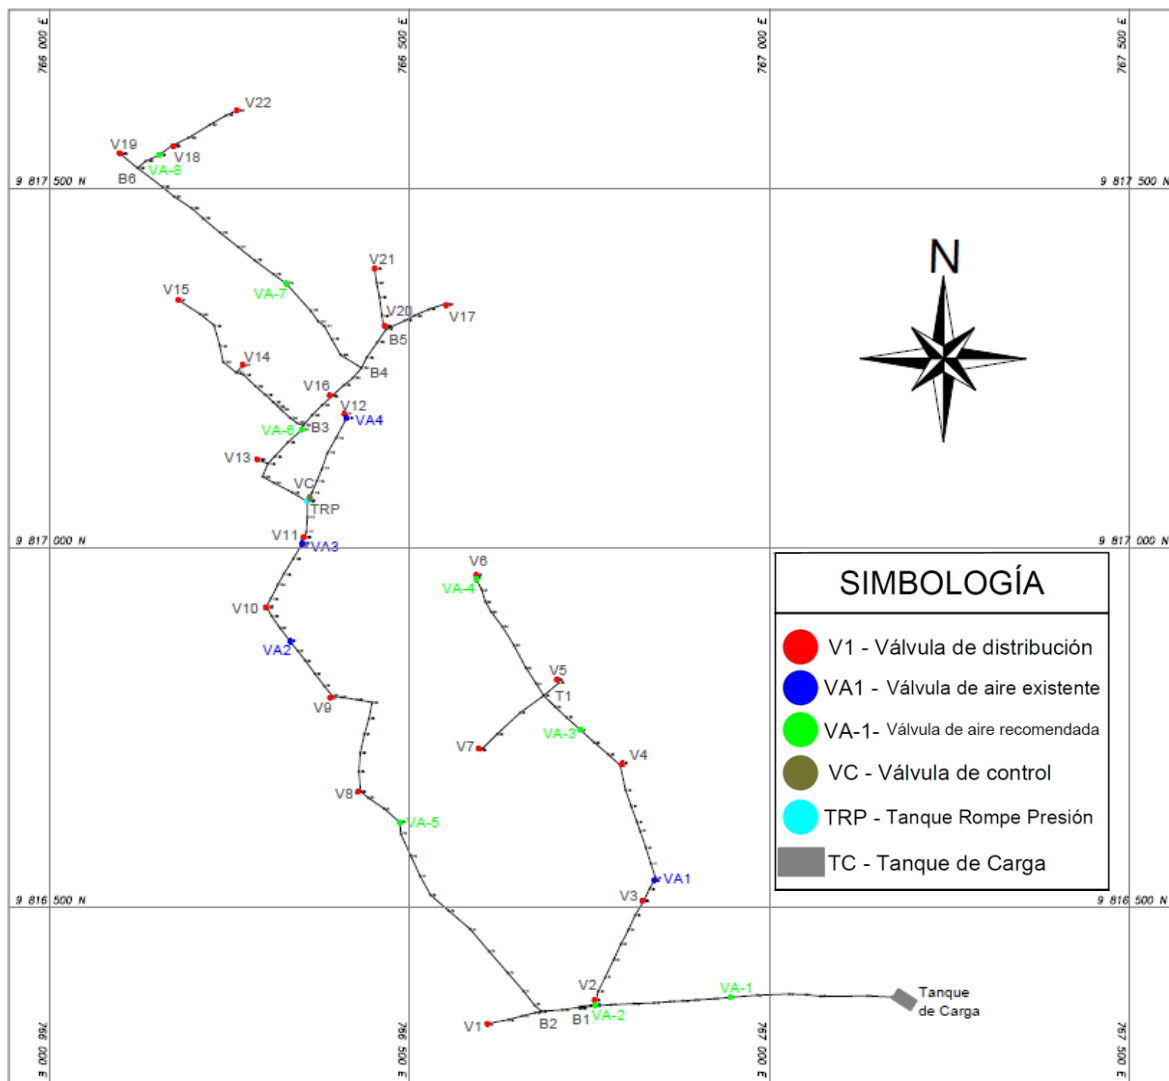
Plano en Planta de Válvulas de aire recomendadas.
